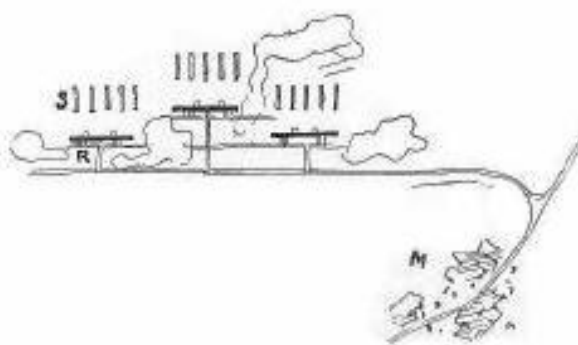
Planta de localização do campo «Murondins». Legenda: R – habitações; S – estaleiros; M – cidade destruída. (Boesiger, 2005, p.94).
